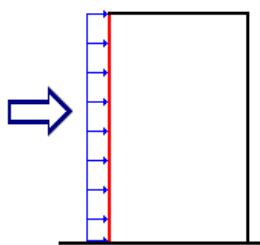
Схема приложения ветровой нагрузки на наветренную сторону
